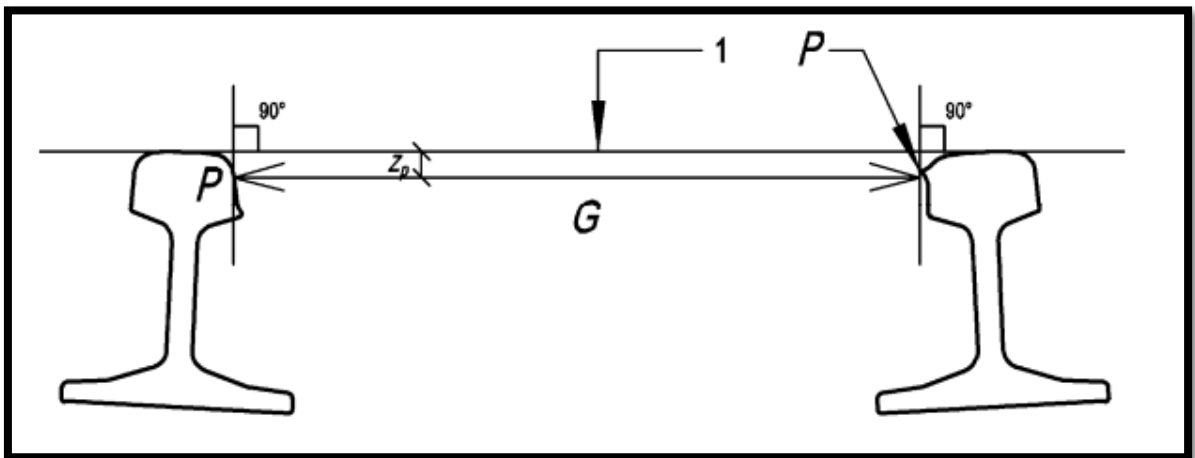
Ancho de vía para un carril desgastado.[8]
